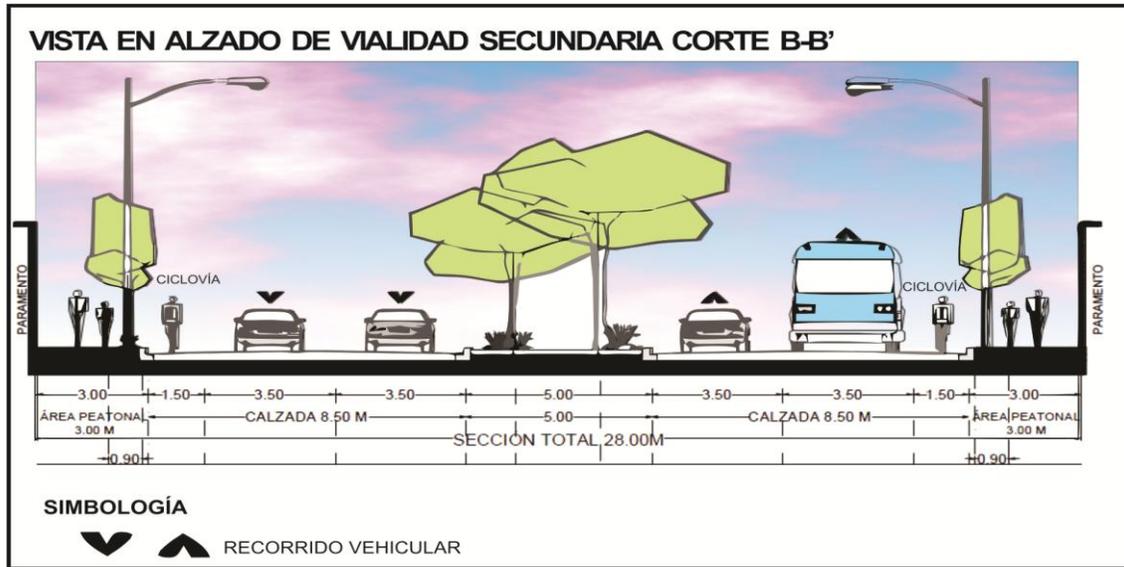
Alzado Secundaria Corte B-B' (Autoría Propia)
